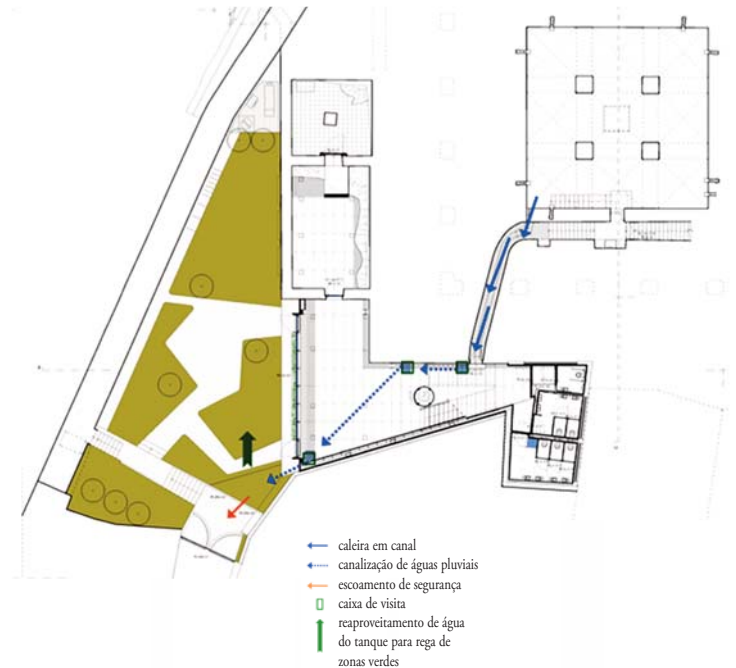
Proposta. Planta do Piso -1. Circuito da água pluvial proveniente da cisterna.
